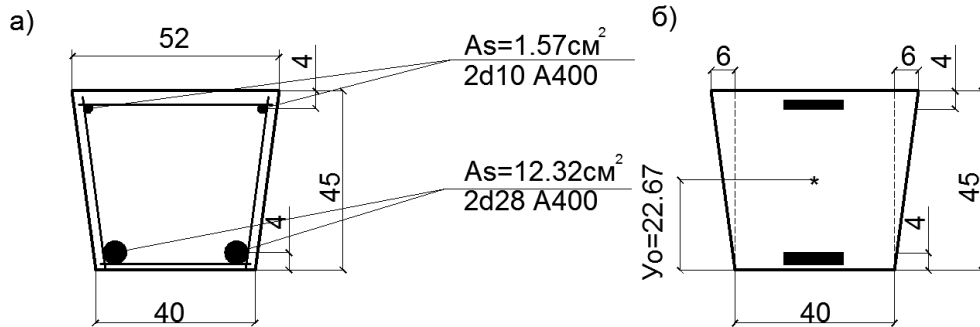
Армирование балки и схема для вычисления центра тяжести
